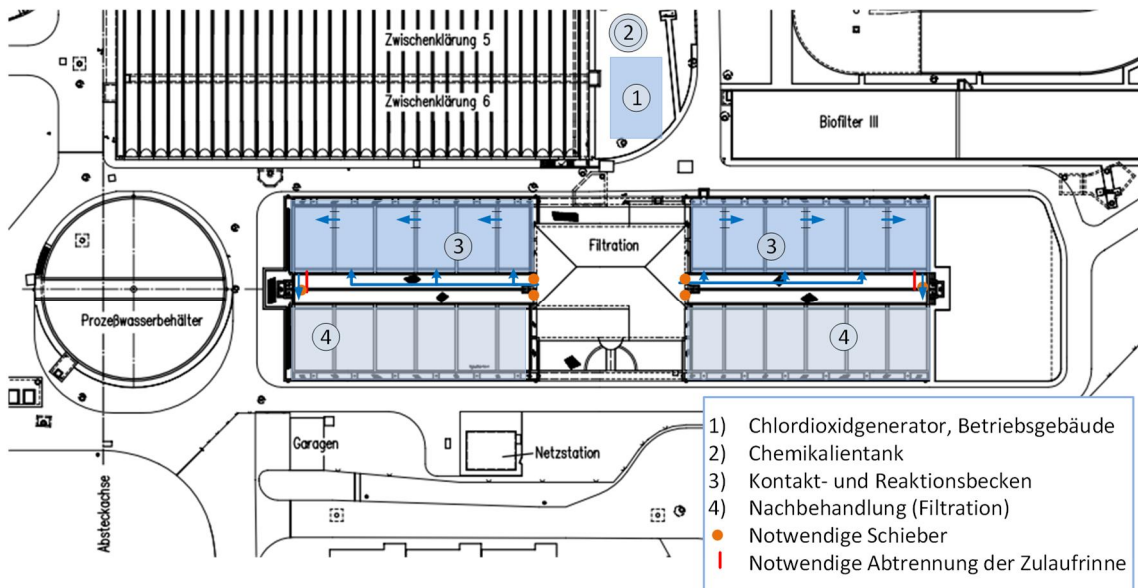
Lageplan der Variante 7 auf dem Klärwerk Krefeld
